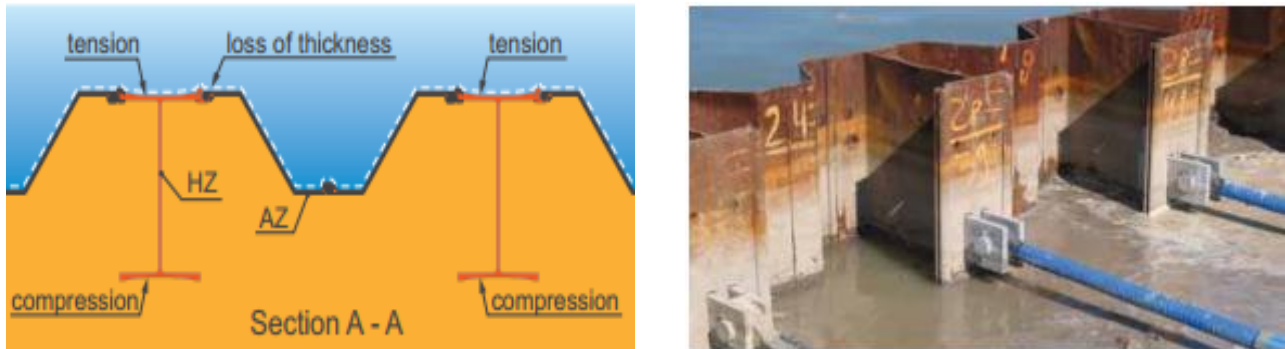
Vue en plan des assemblages de rideaux de palplanches d'acier (HZ1180MA-12 et AZ20-700)(Arcelor Mittal, 2013)
